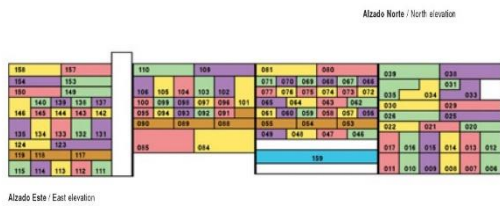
Alzado corte con tipologías. (ElCroquis, 2016)
